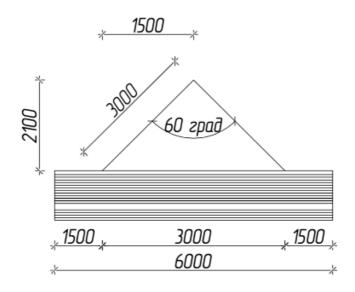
Расчет длины двухветвевого стропа для монтажа пучков арматуры и опалубки
